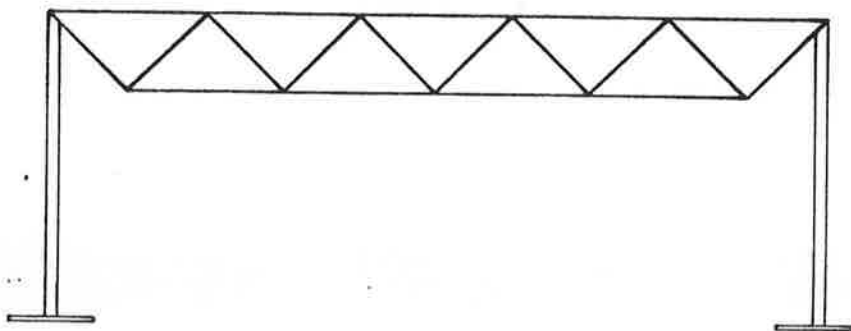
Vigamento horizontal de apoio das chapas.
